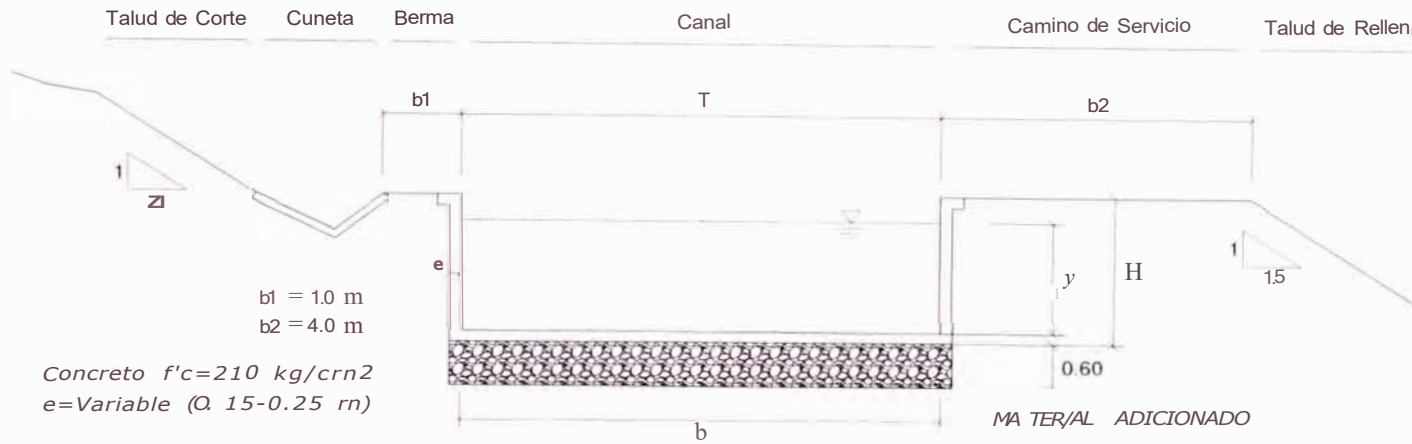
Sección Típica de Reemplazo de Material Adicionado en Canal Rectangular
